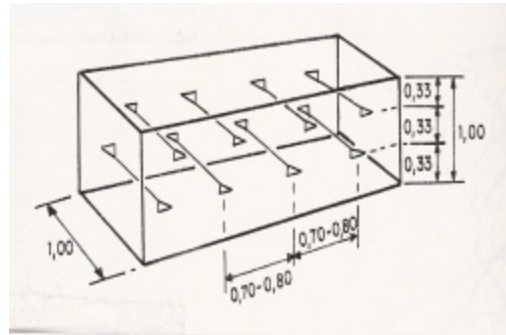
Detalle de tirantes horizontales. (Suárez, 1993)
